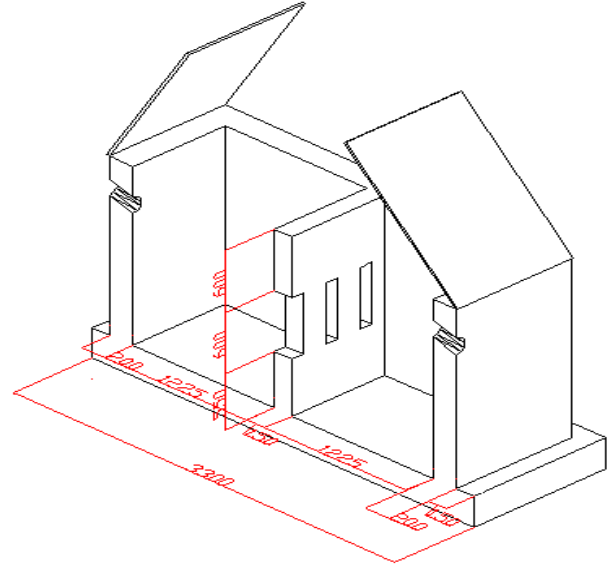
Yapay sulak alan giriş yapısı taban planı ve kesit kısmı görünüşü
